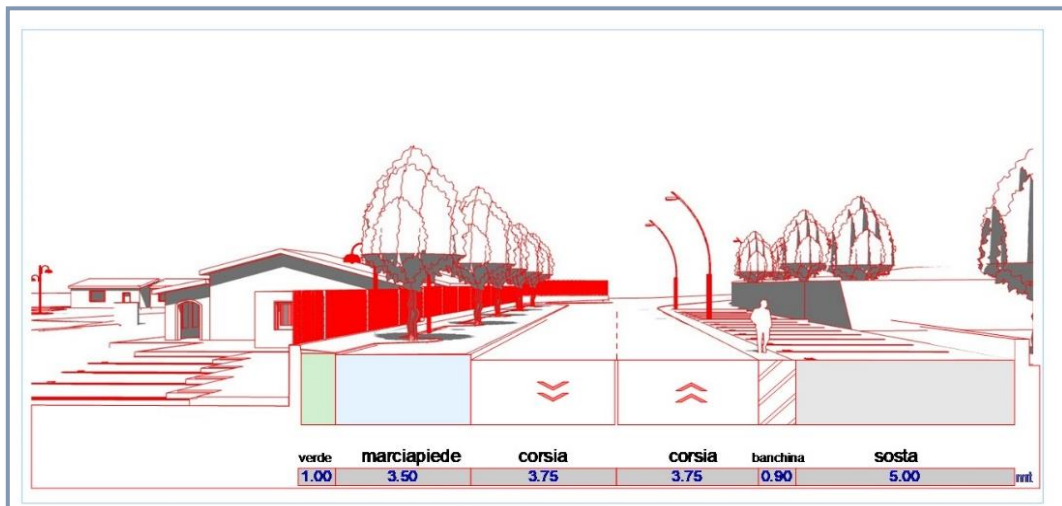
sezione prospettica di progetto di viale Raf Vallone.
